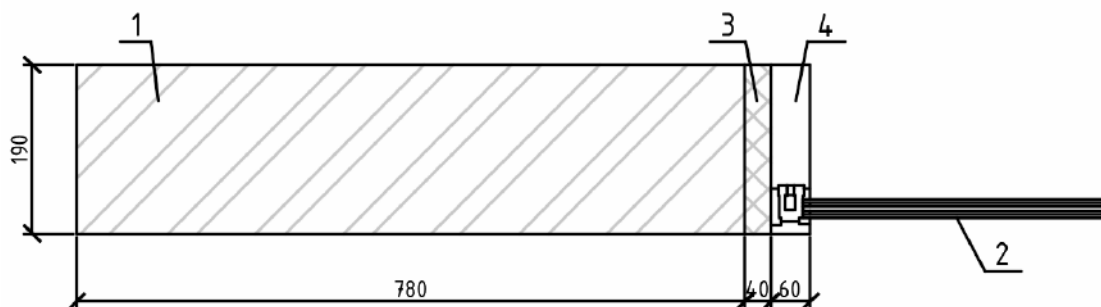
Схема сечения узла примыкания оконного блока к стеновому проему без утеплителя и без дефекта
